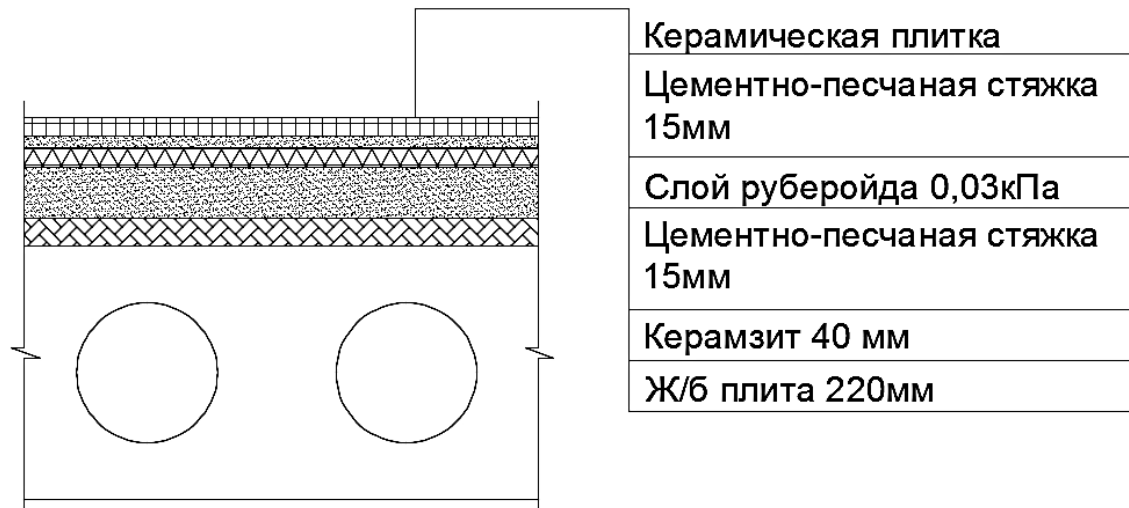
Сбор нагрузок на 1м² межэтажного перекрытия(санузел).
